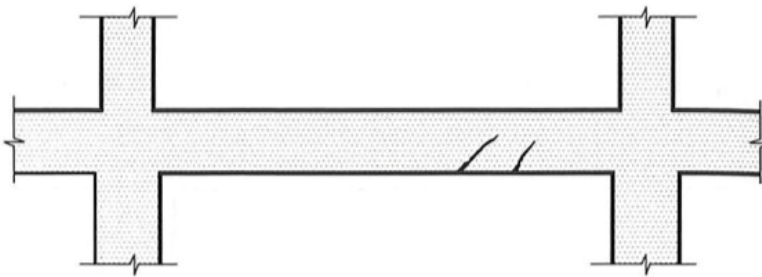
Fisuras inclinadas en viga (Fuente: Calavera, 2005)
